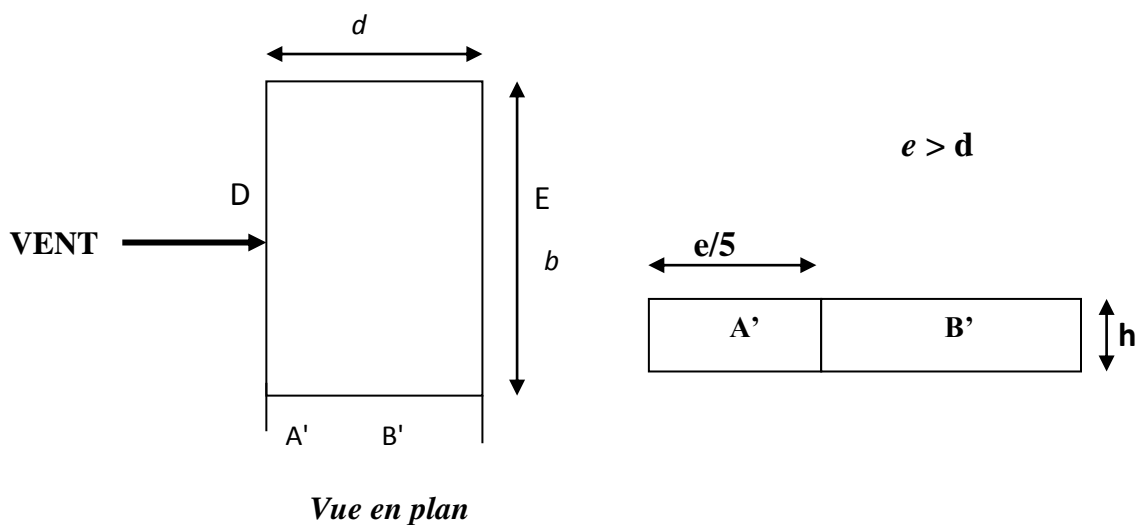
Vue en plan et vue en élévation, sens XZ.
